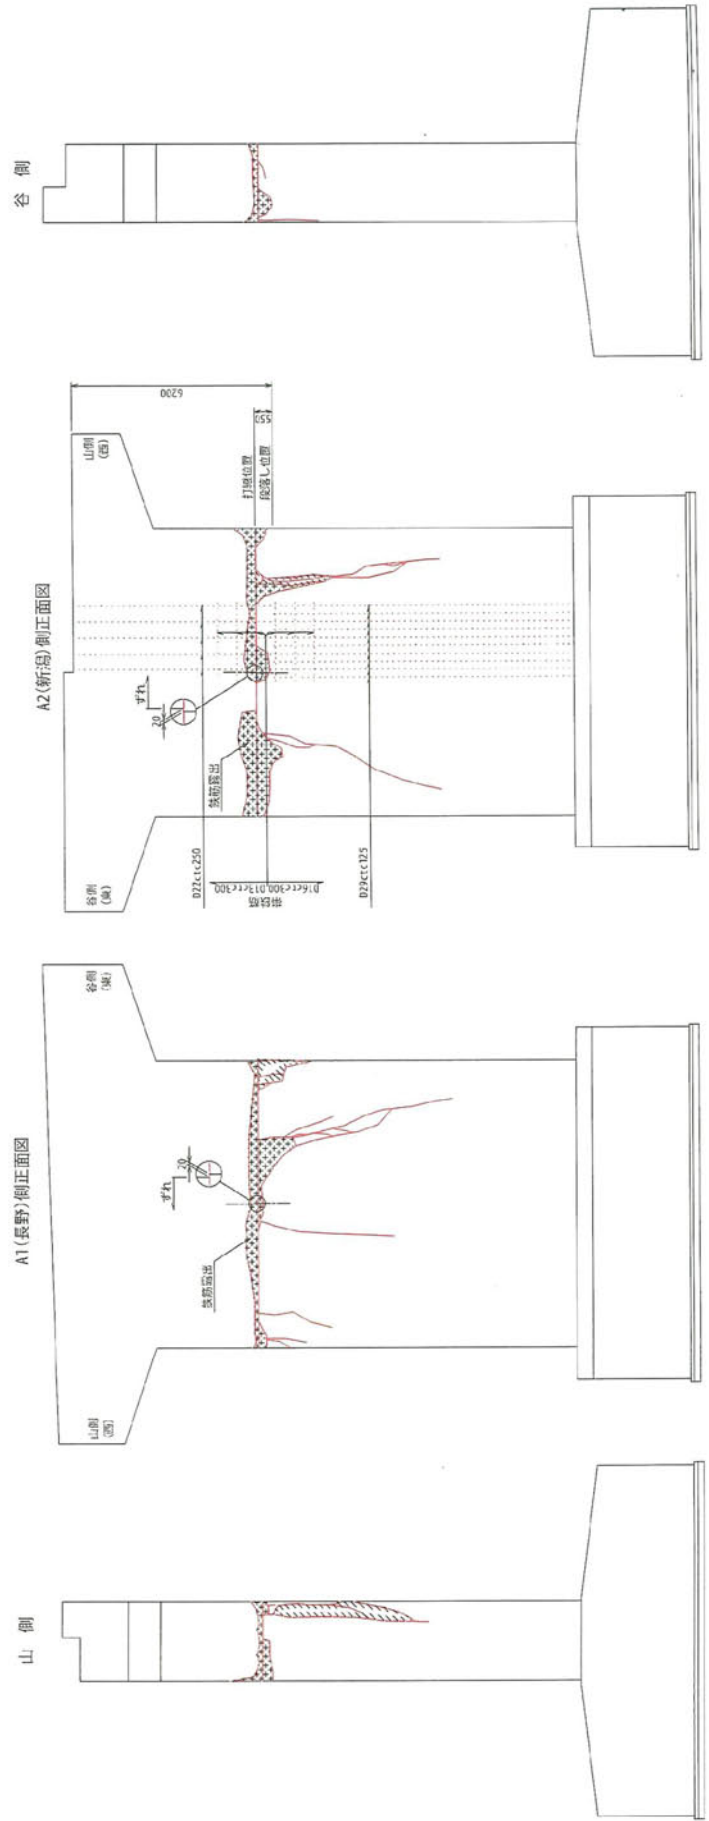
P1 橋脚の損傷状況 (資料提供：長野県)
